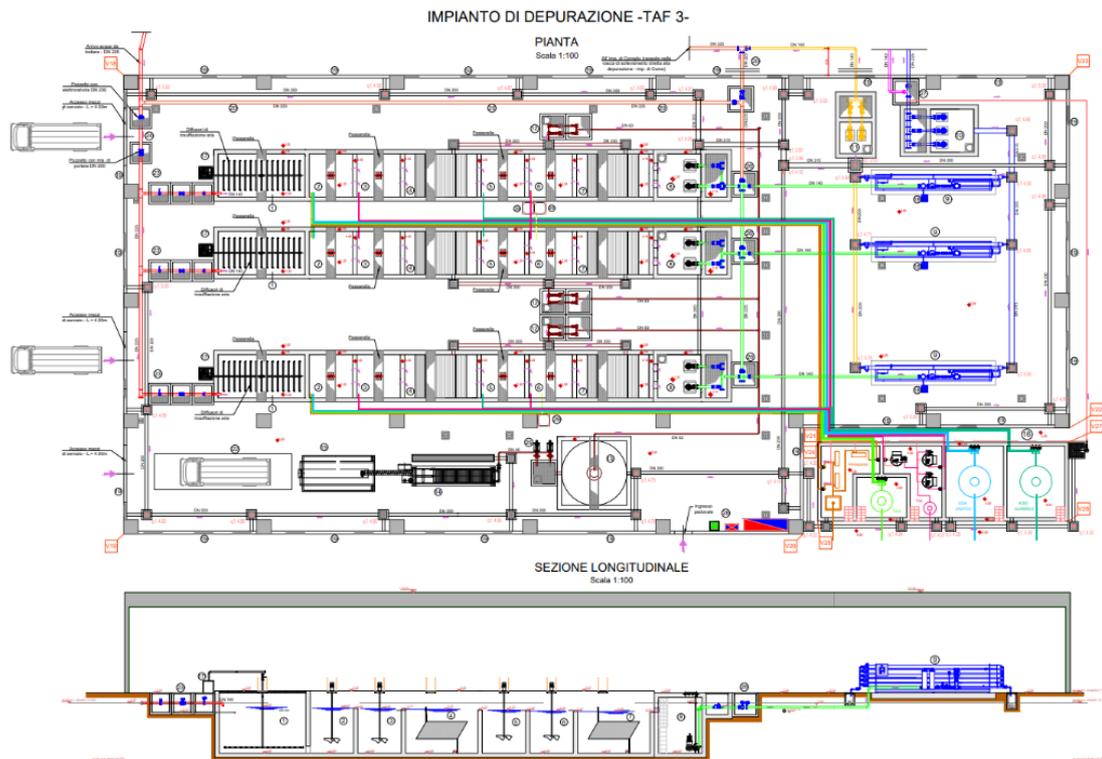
Impianto di Depurazione TAF3 - Piante e sezione
